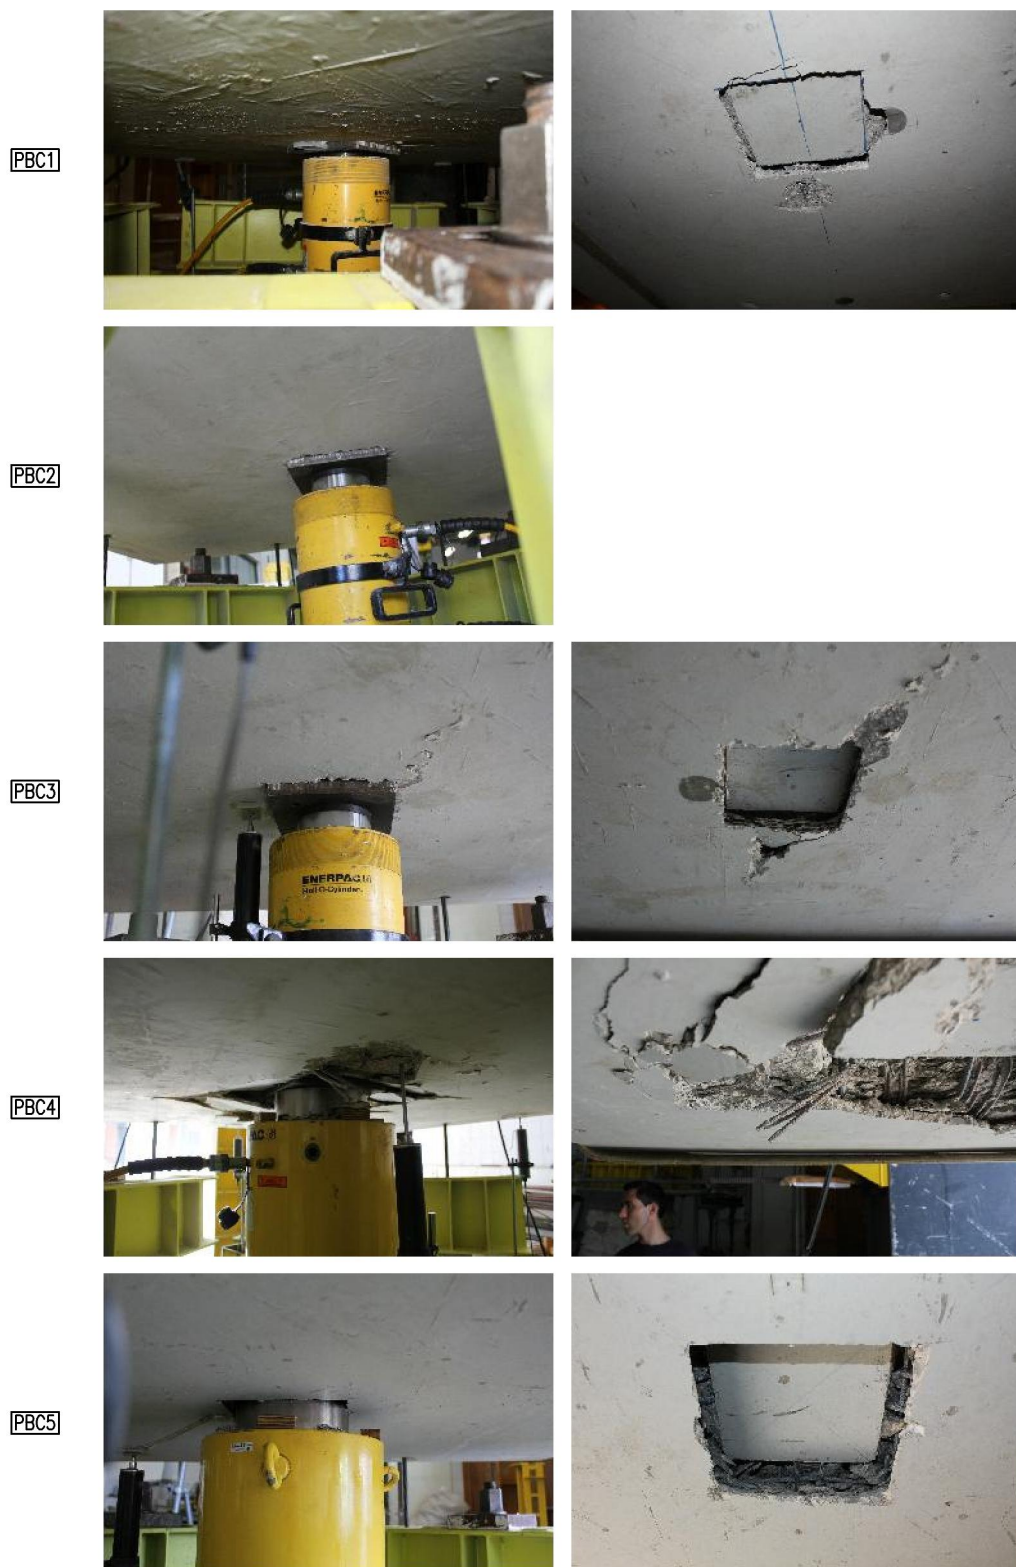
Fotografias da rotura na face inferior das lajes.
